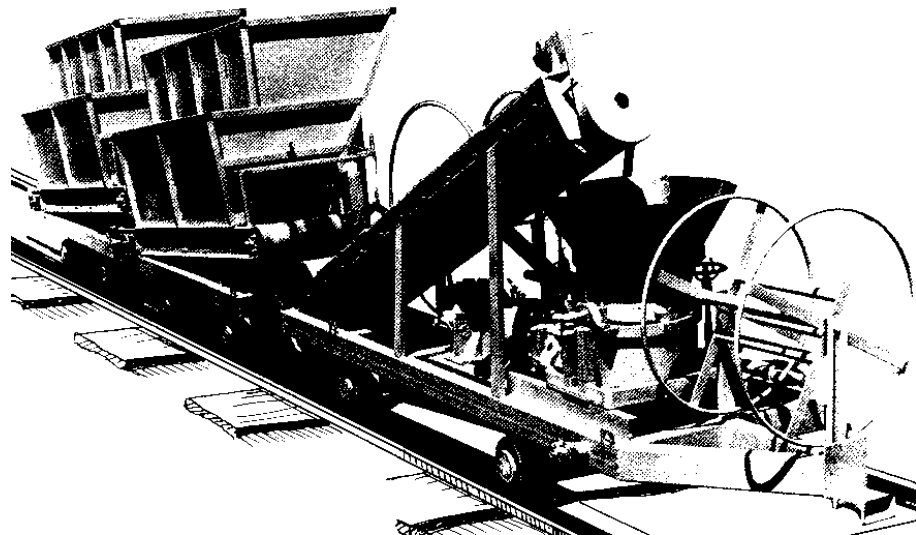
Vista de cómo se arma el tren de lanzado.
